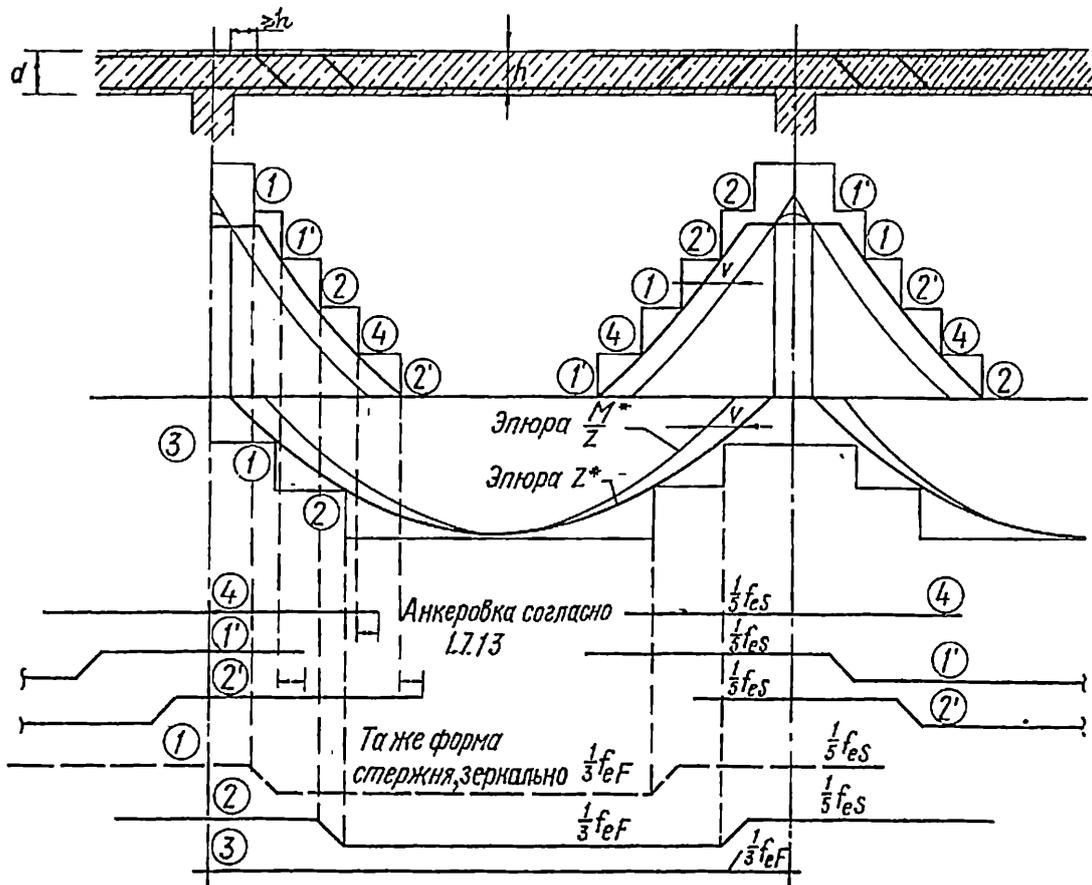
Армирование неразрезных плит: эпюра материала в случае стержневой арматуры
